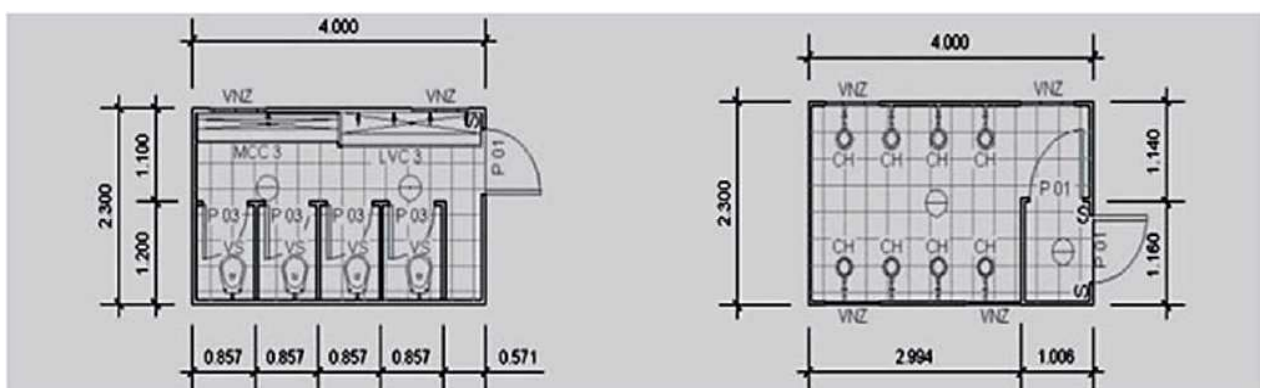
Exemplo de instalações sanitárias usuais para canteiros.
